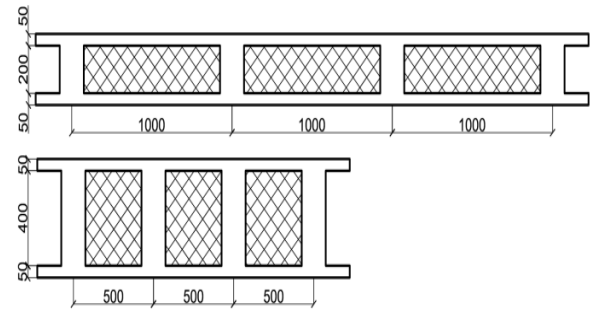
Поперечные сечения рассматриваемых плит перекрытия
